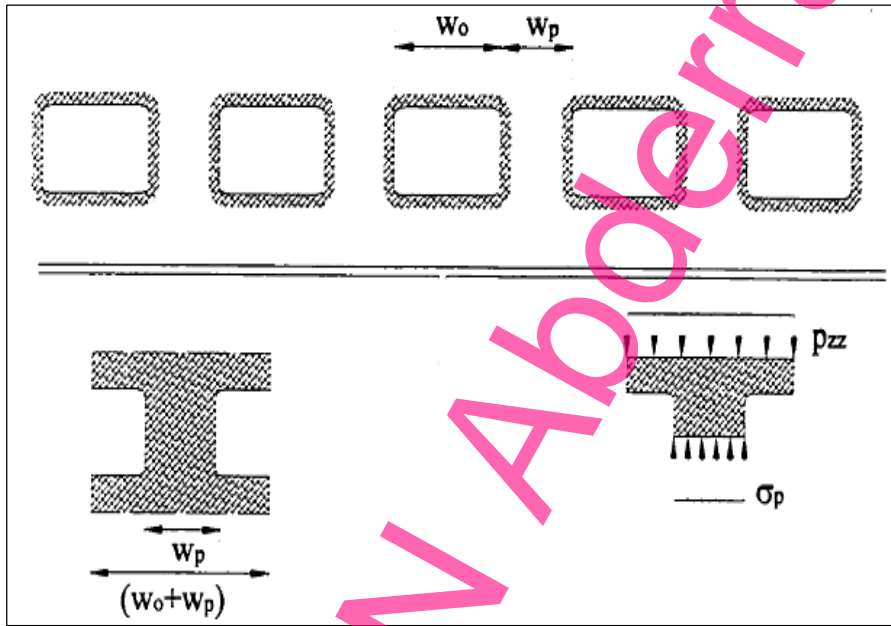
Théorie du bloc tributaire cas de piliers mur montrés en section longitudinale [27]
